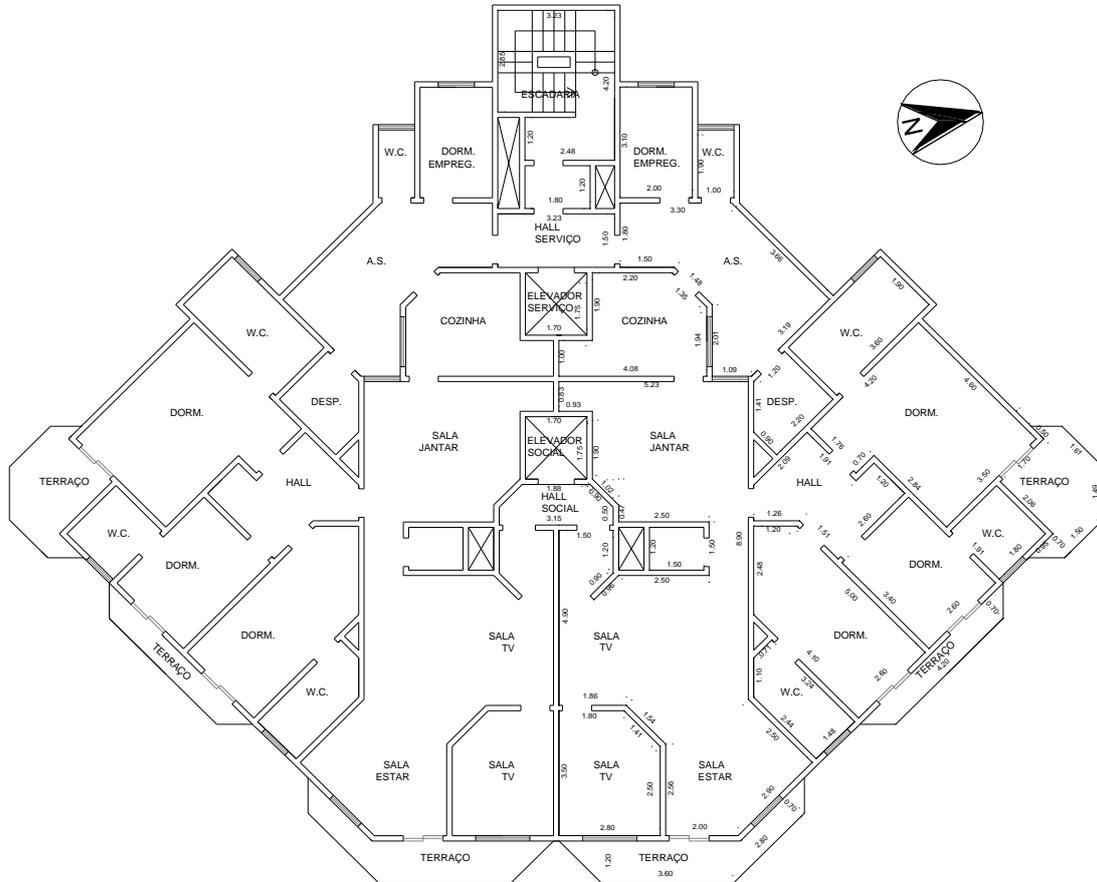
Planta do pavimento-tipo – Residencial San Marcos.
